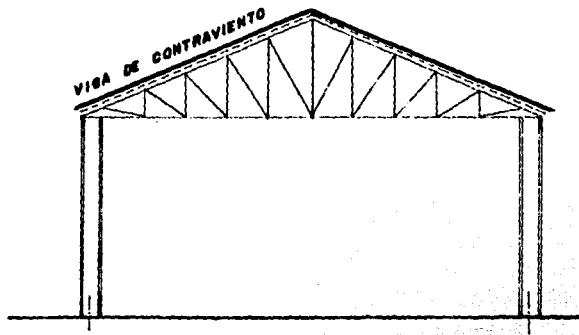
Disposición de la viga de contraviento en la cuerda superior de la armadura de techo.
